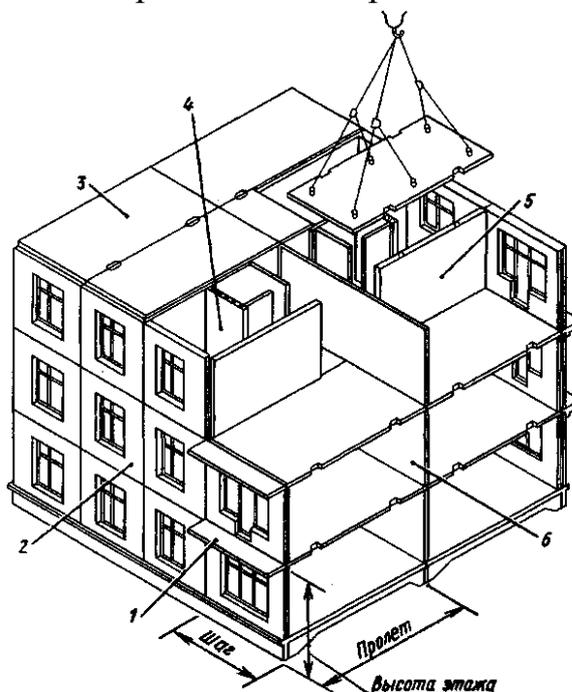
Монтаж сплошных плоских железобетонных плит перекрытий
